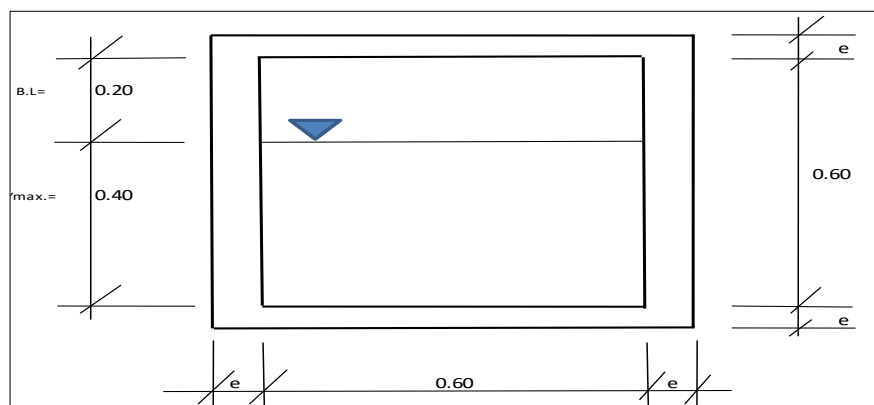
Sección típica de alcantarilla de alivio proyectada (Fuente: Elaboración propia)
